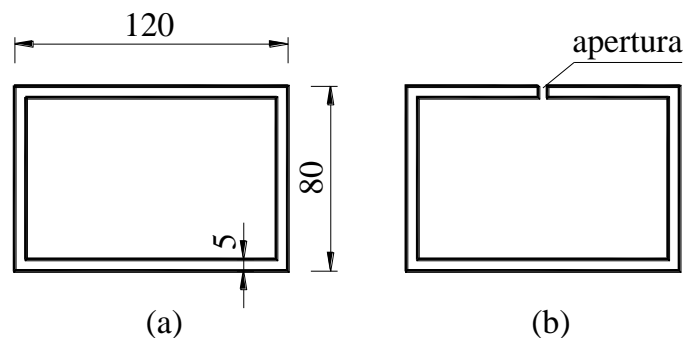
Sezioni trasversali di membrature in torsione – (a) sezione scatolare rettangolare, (b) sezione rettangolare con apertura.
